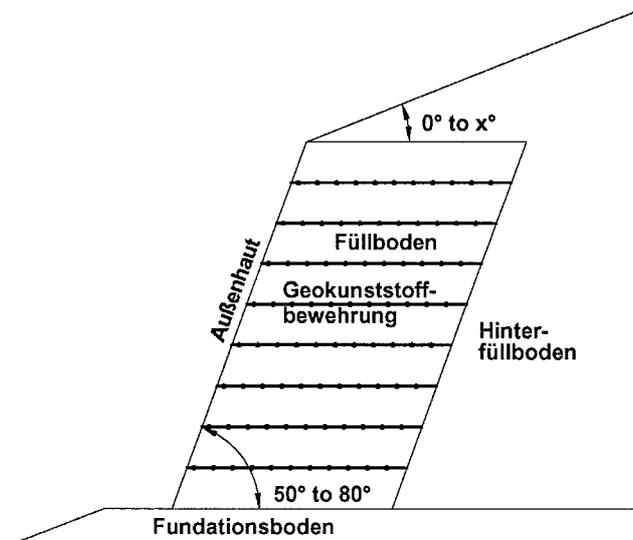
Typisches Schema einer geokunststoffbewehrten Böschung
